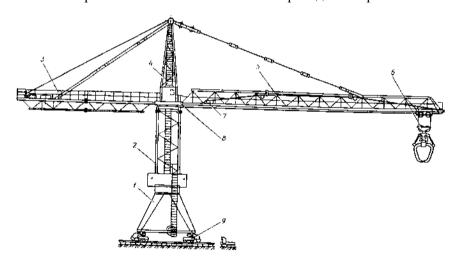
Кран башенного типа КБ-572А: 1 — портал; 2 — неповоротная башня; 3 — консоль противовеса; 4 — оголовок; 5 — стрела; 6 — обойма с грейфером; 7 — лебедка; 8 — опорно-поворотное устройство; 9 — ходовая тележка
